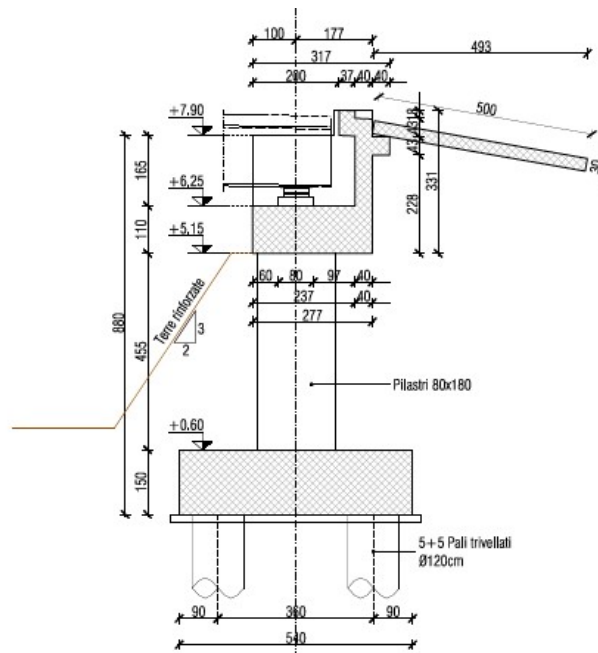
SPALLA CAVALCAVIA CALVECCHIA – SEZIONE
